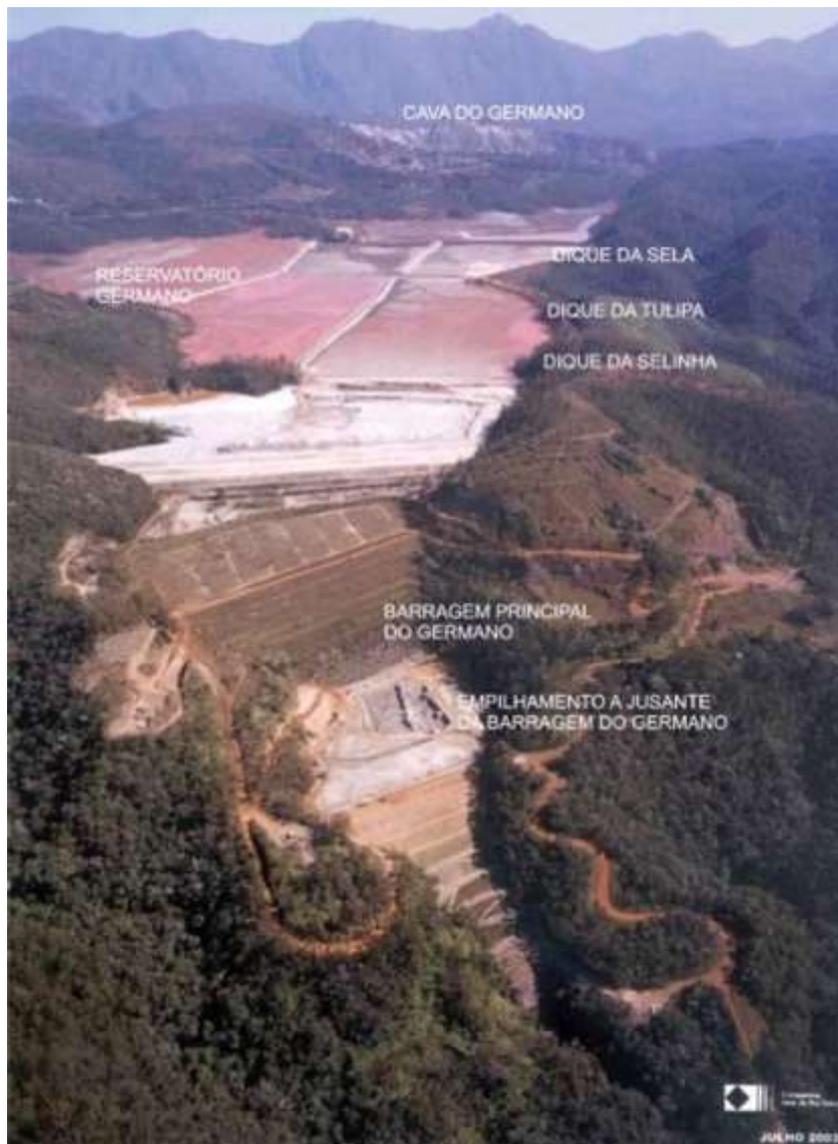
Vista da Barragem do Germano (empilhamento drenado)
